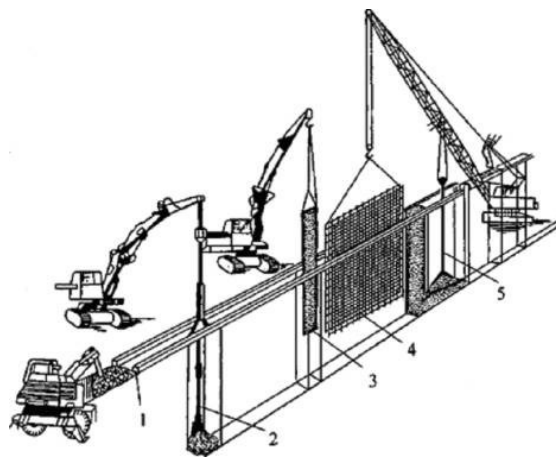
Технология работ по устройству ограждения будущего котлована монолитной стеной в грунте: 1 – устройство форшахты; 2 – разработка участка траншеи грейфером; 3 – установка ограничителей по краям участка траншеи; установка в траншею арматурного каркаса; 4 – бетонирование участка стены методом вертикально перемещаемой трубы
